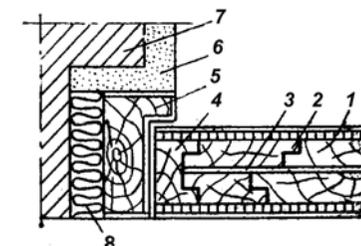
Конструкция деревянной противопожарной двери: 1 — слой фанеры ФСФ; 2 — доски, подвергнутые огнезащитной обработке; 3 — слой асбеста; 4 — обвязка двери; 5 — дверная коробка; 6 — штукатурка; 7 — стена; 8 — прокладка.
